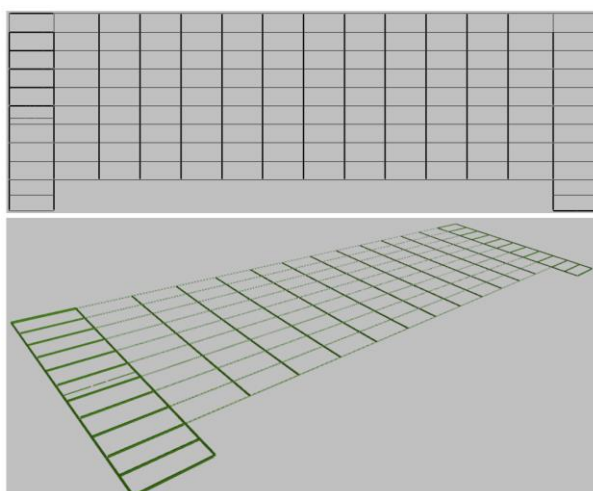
CYPE 3D – Cubierta norte, cordón inferior.
